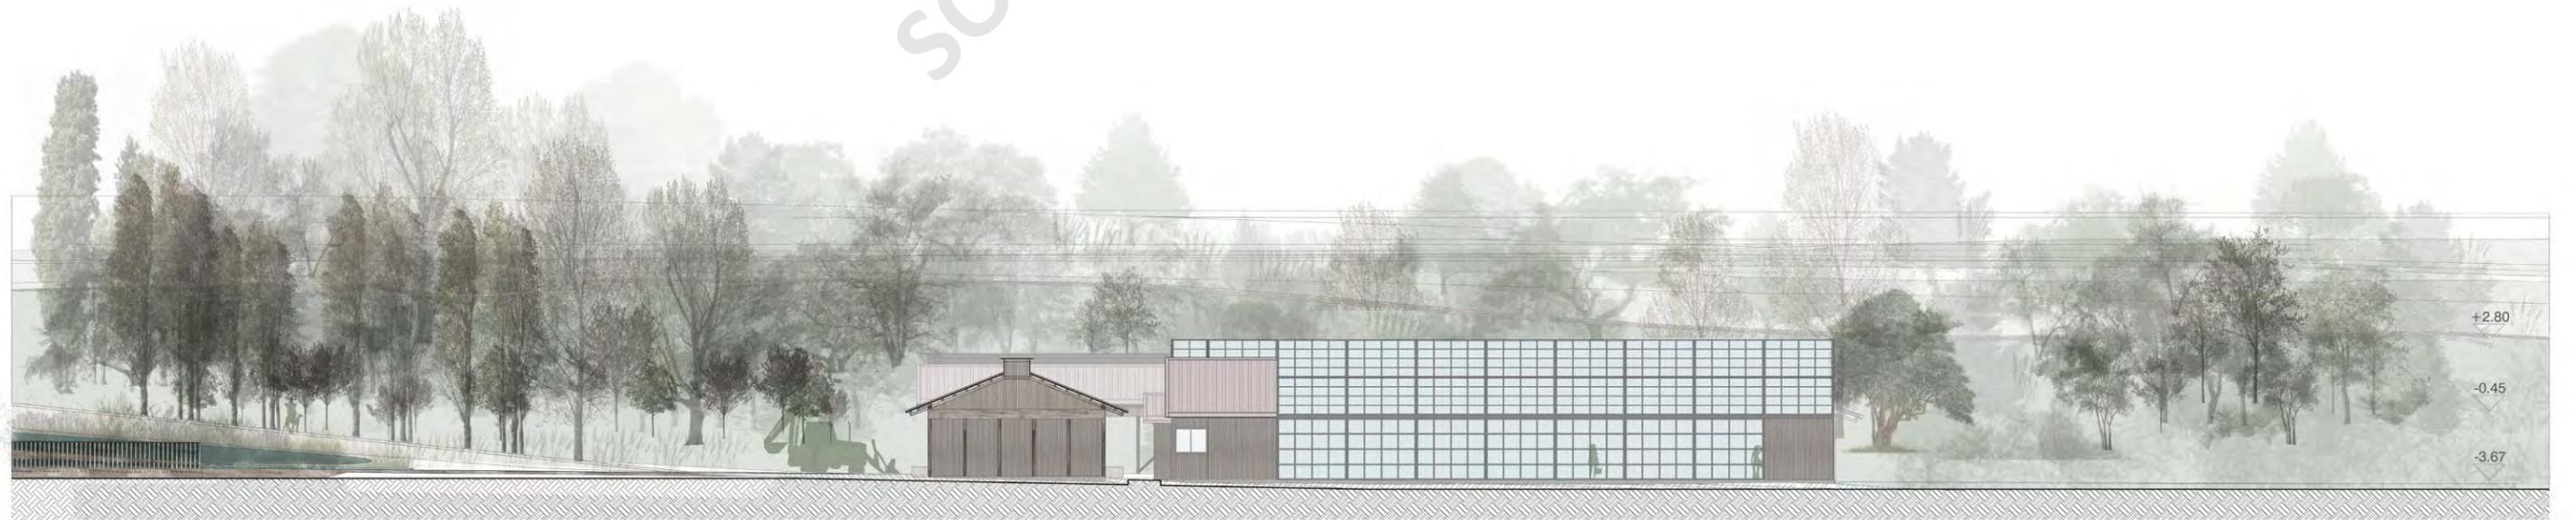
Elevación sur B. Planimetría de elaboración propia.
